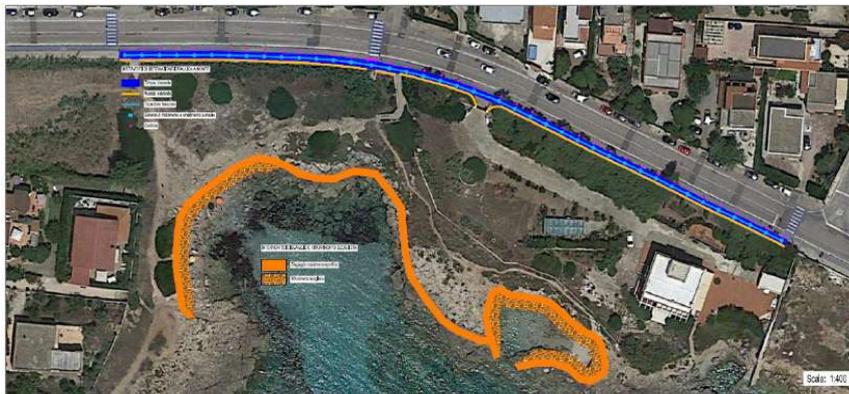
Planimetria generale di intervento (da “T06_Planimetria generale di progetto”)
